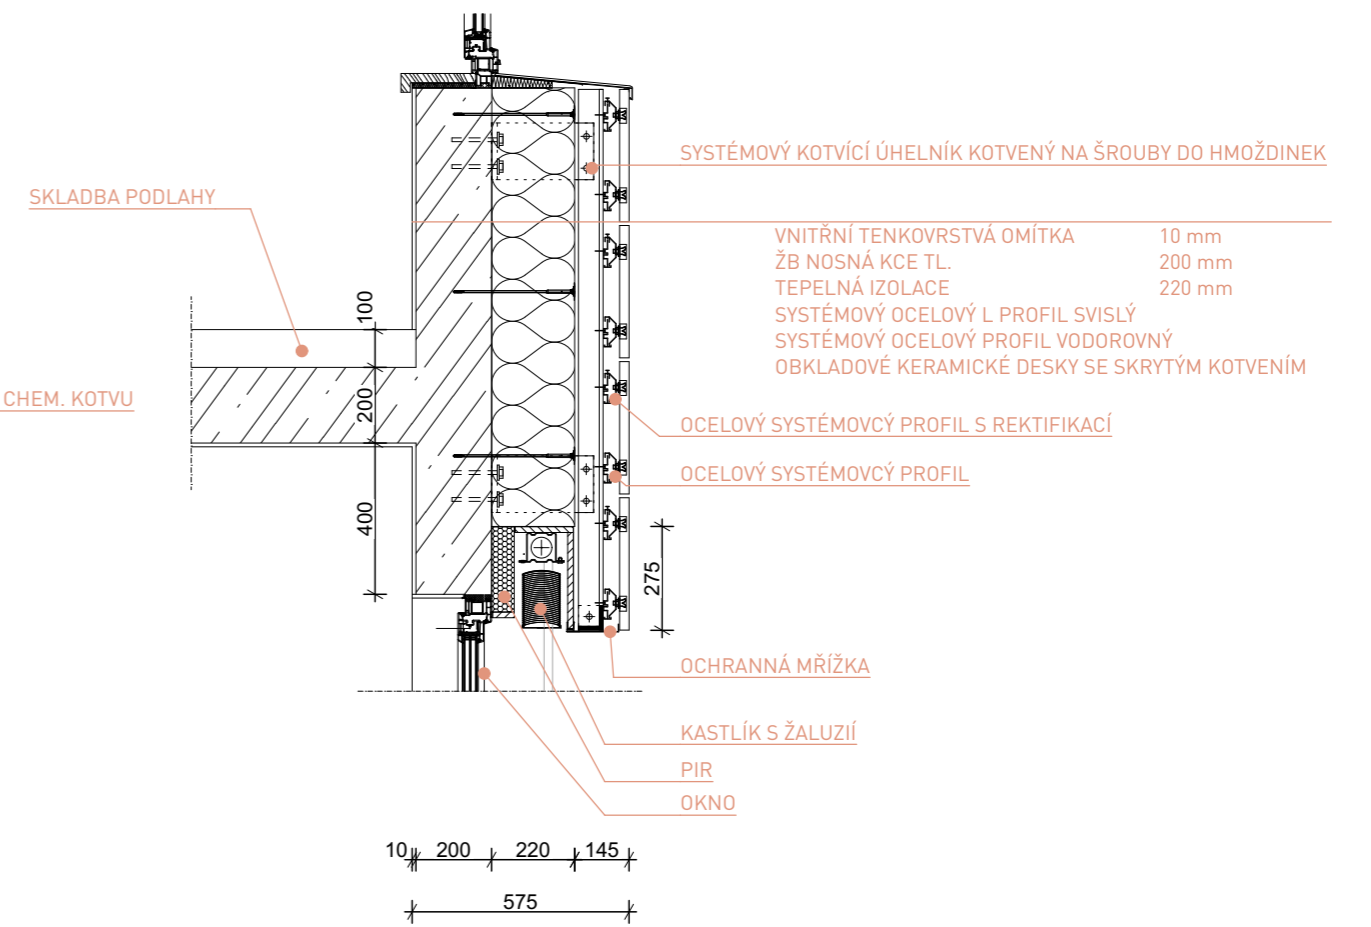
DETAIL BALKONU A NADPRAŽÍ S KONTAKTNÍ FASÁDOU S KERAMICKÝM OBKLADEM
